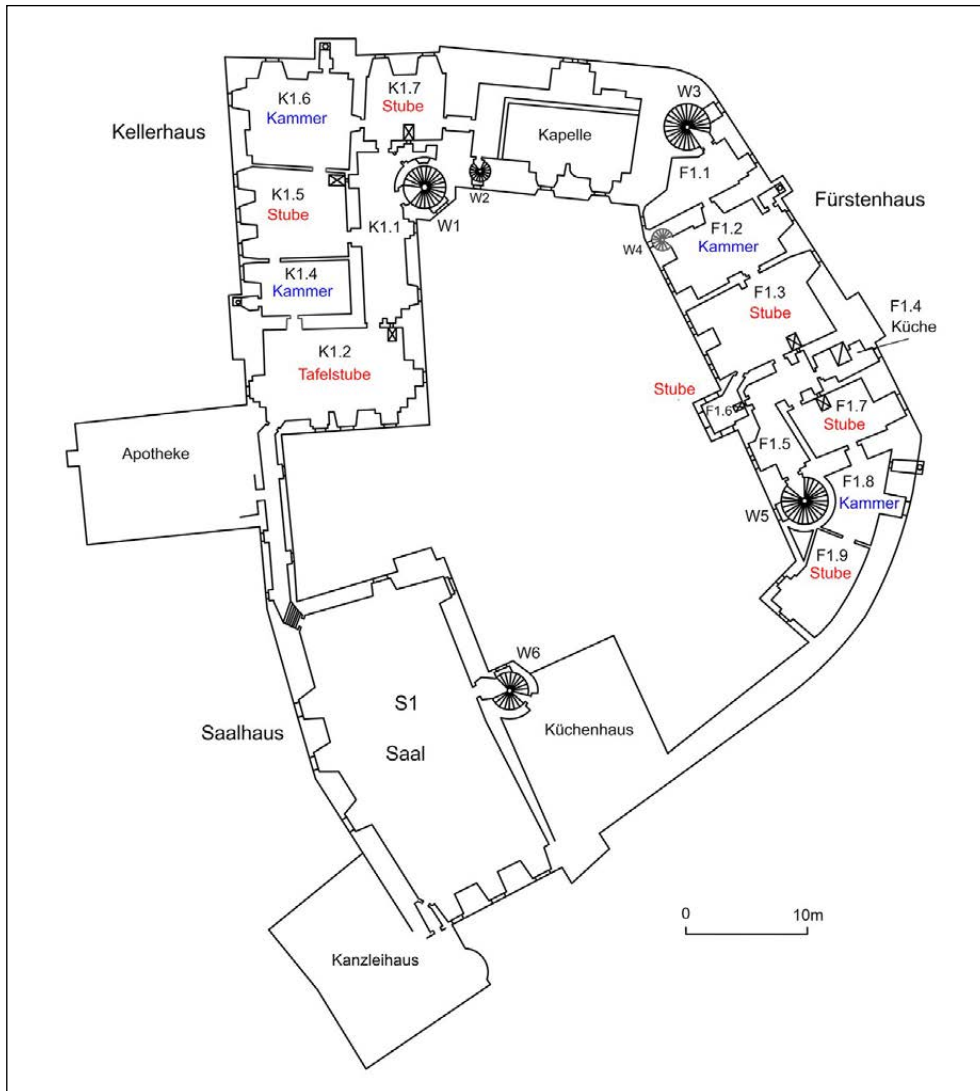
Colditz, Schloss Colditz, erstes Obergeschoss, Grundriss, Rekonstruktion der Raumfunktionen 1603–1622
